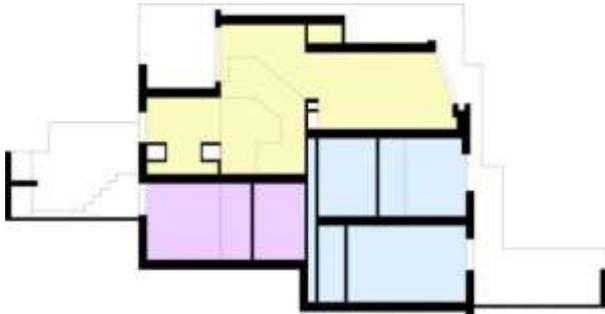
Sección vivienda de tres plantas en Wates. Azul: zona de noche; Amarillo: zona de día; Morado: zona de servicio.
